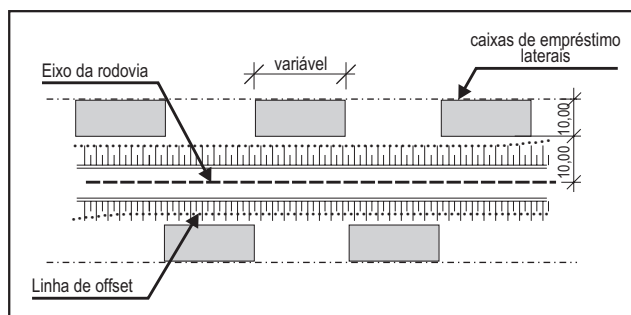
Localização dos empréstimos laterais – Vista em planta
